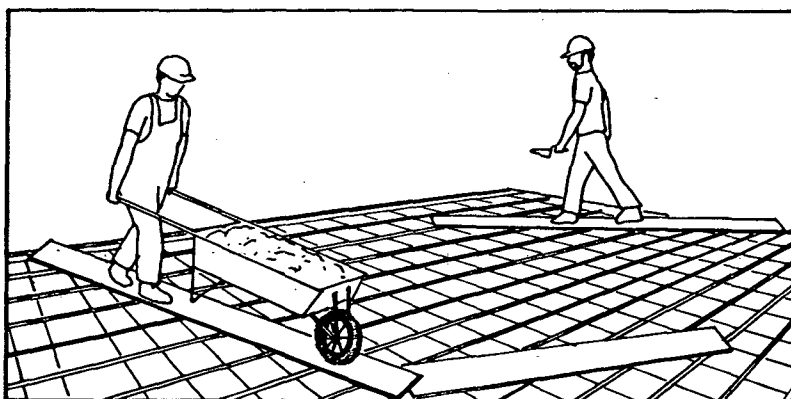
TRÂNSITO SOBRE LAJE INACABADA
